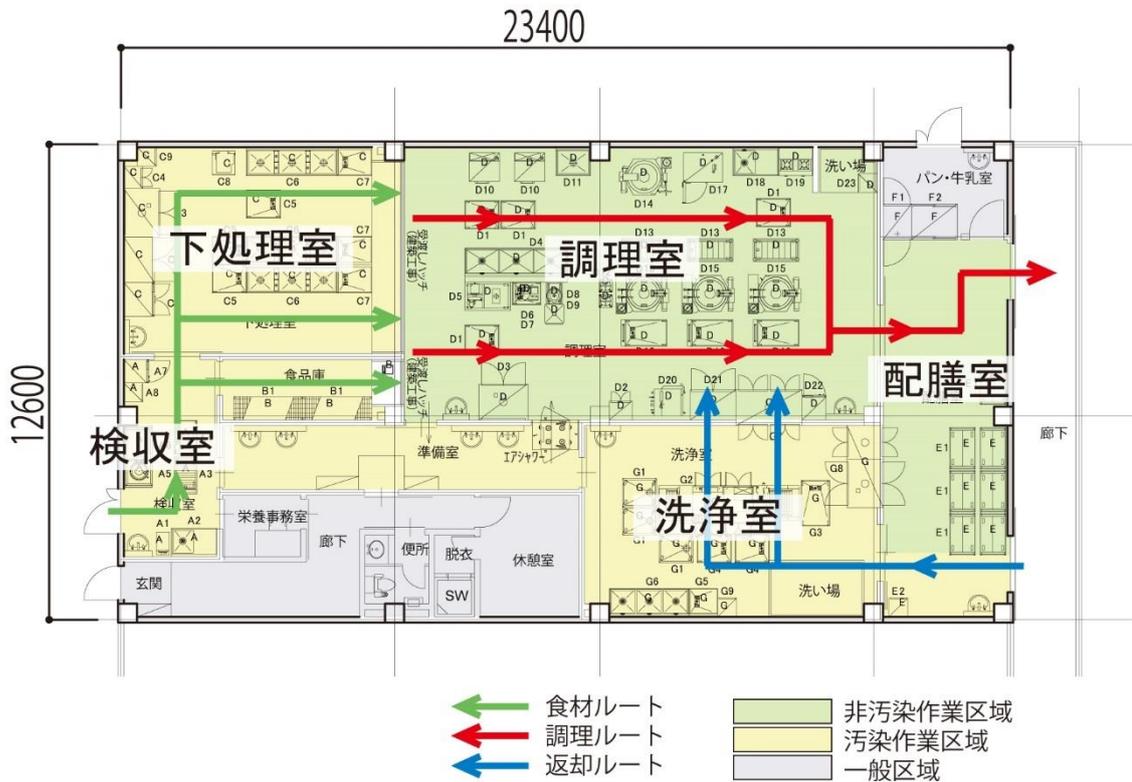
給食室想定平面図 (モデル2 400食 336.96 m²)
